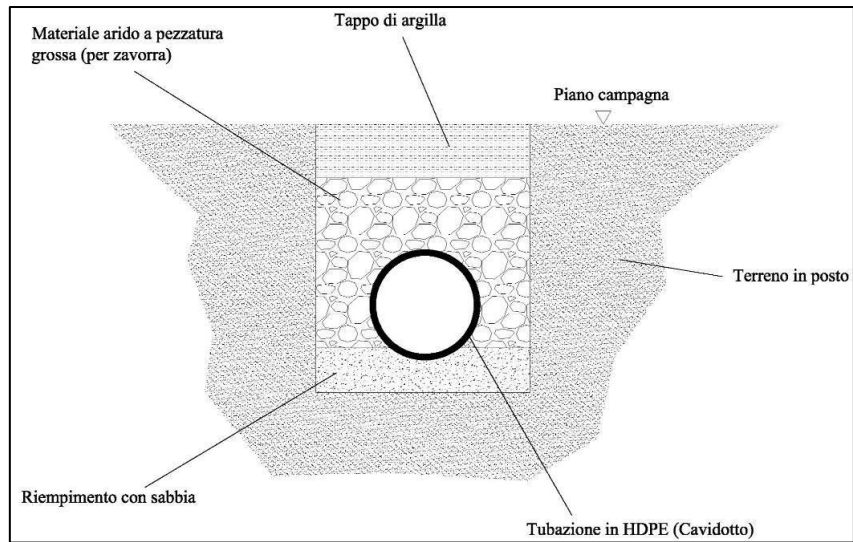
Schema di attraversamento con zavorraggio e tenuta idraulica supplementare
